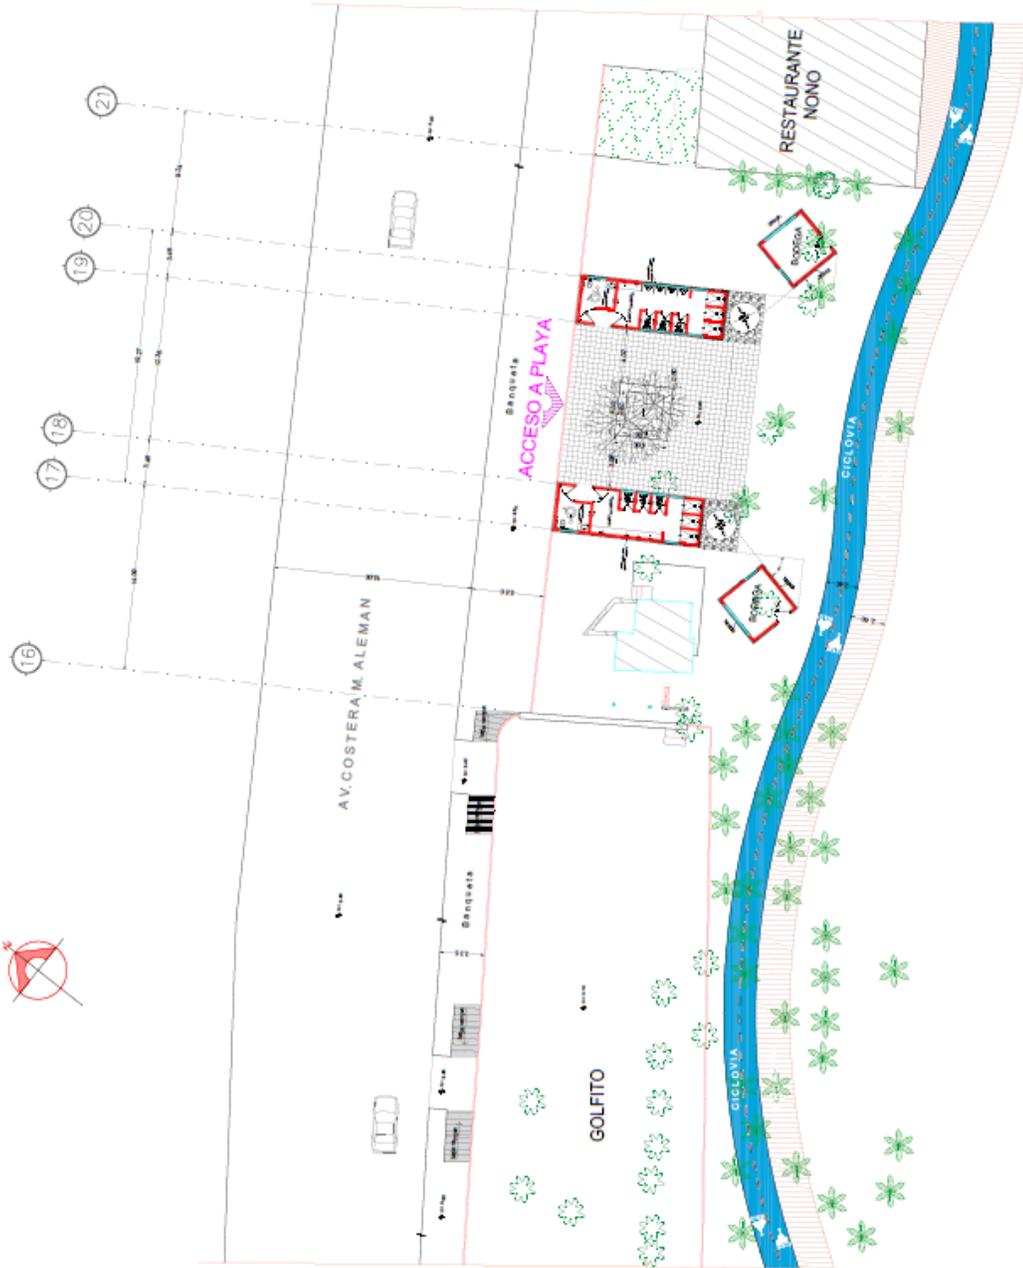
Planta arquitectónica de ciclo vía, andador y acceso a playa.
